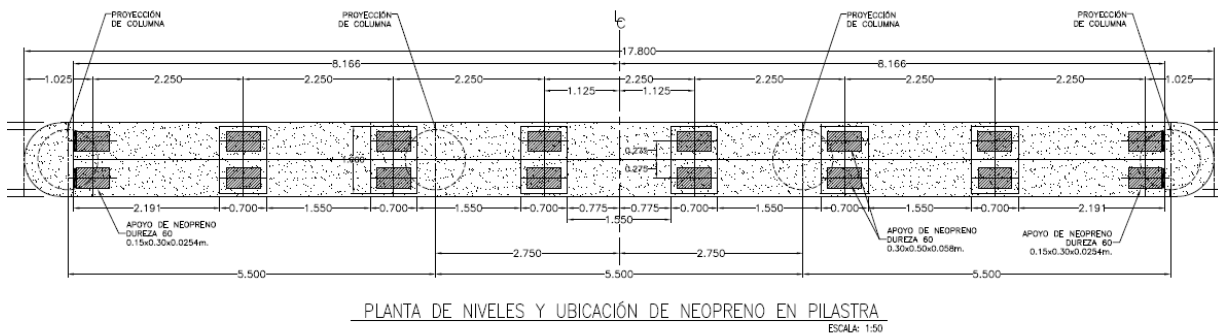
Planta de Niveles y Ubicación de Neopreno en Pilastra.
